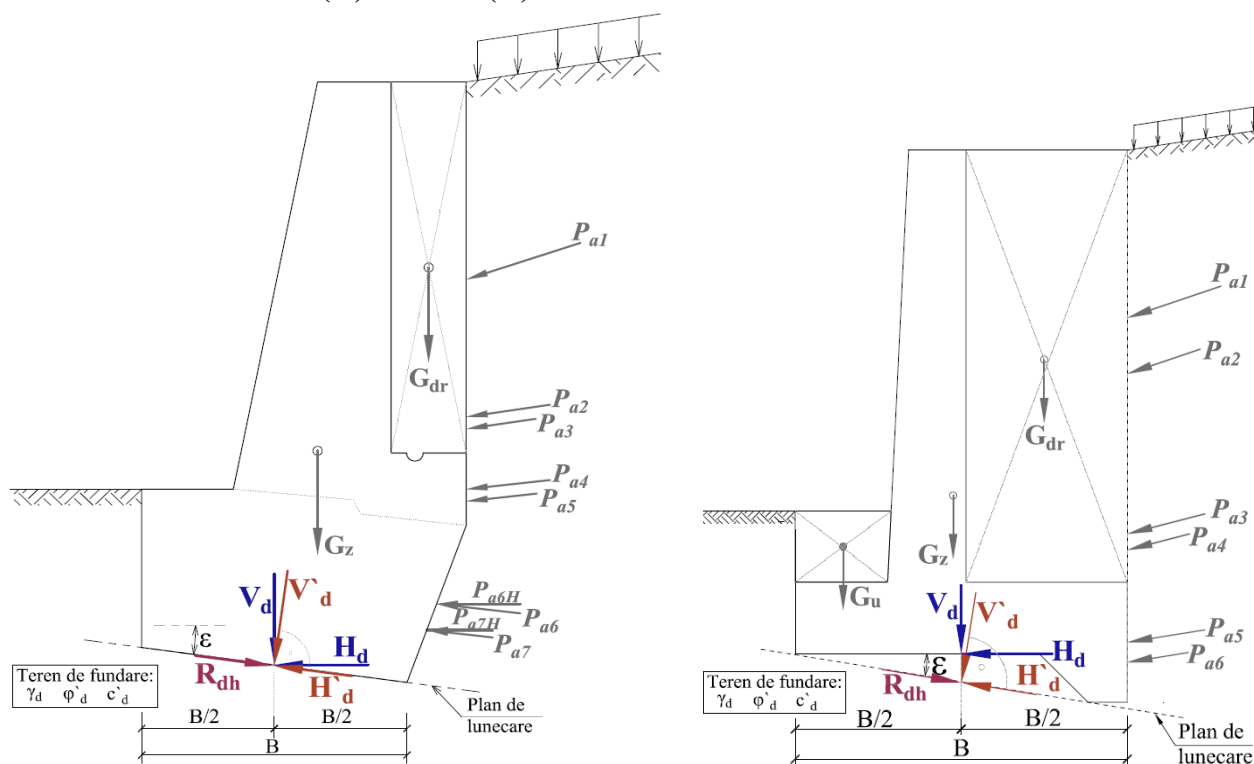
Proiecția forțelor reduse la centrul fundației după planul de lunecare (zid de sprijin din beton simplu/zidărie de piatră și din beton armat)
